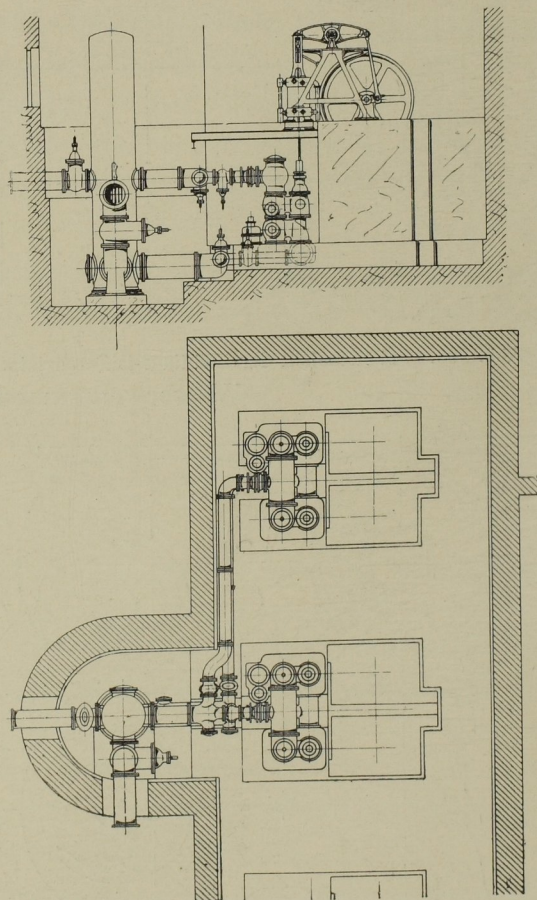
Grundriss der Anlage. Rohrplan. Masst. 1:250.
